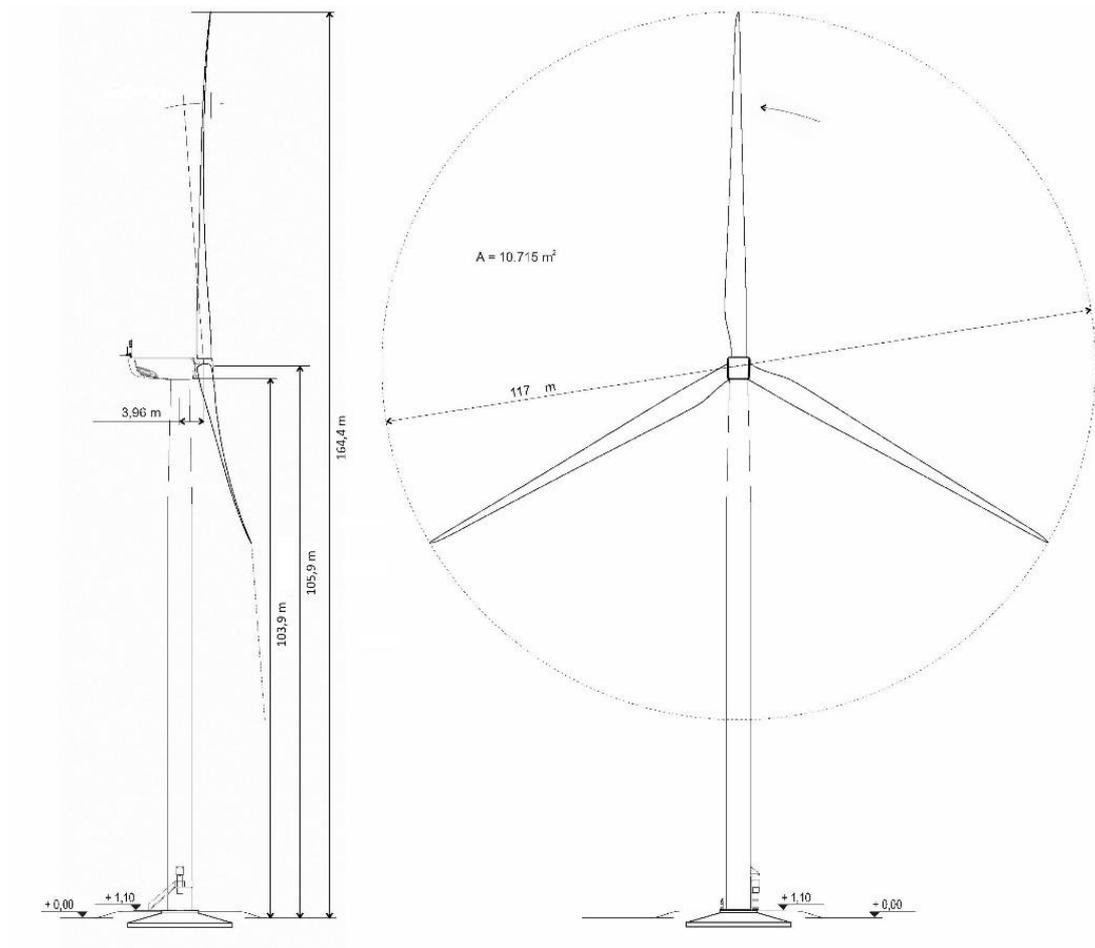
Plans en coupe de l'éolienne N117 – 3,6MW – 164 m
